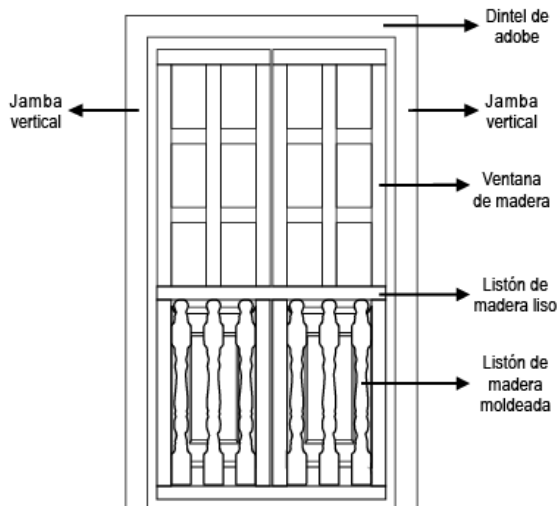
En la ilustración se observa la ventana de la planta alta tipo balcón original de la vivienda con un diseño ecléctico.
